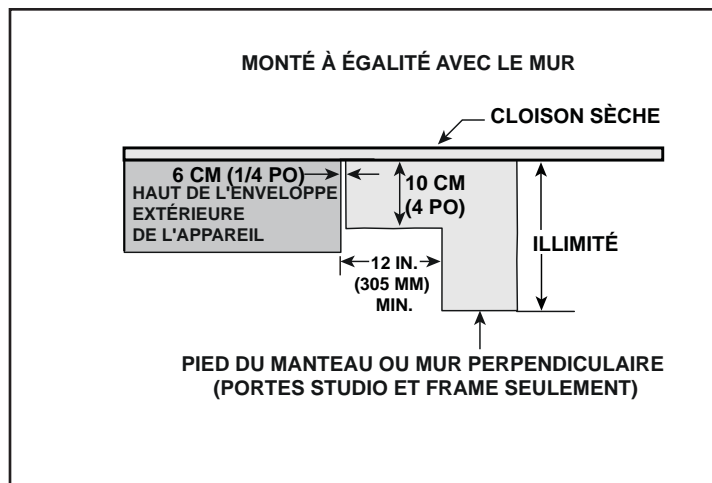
Dégagements du pied du manteau du foyer ou saillie du mur (acceptable de part et d'autre de l'enveloppe extérieure)
